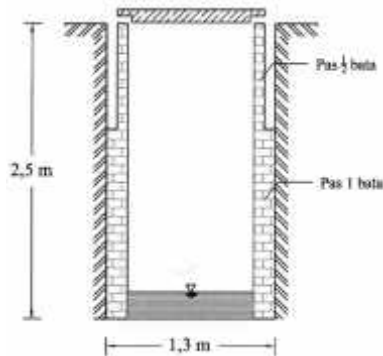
Denah sumur resapan air hujan Kecamatan Gondang Rejo
